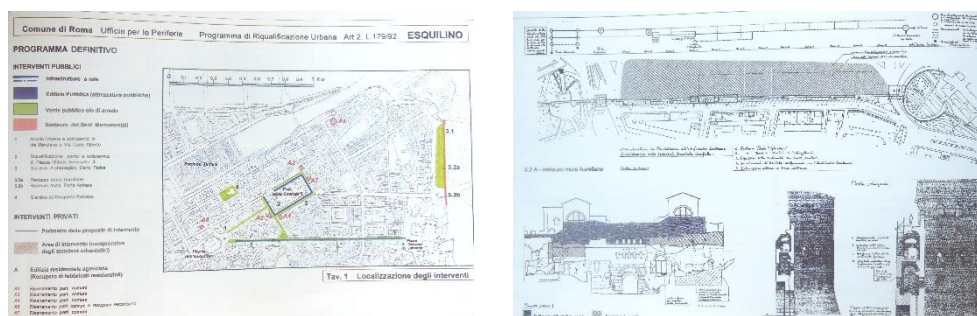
Roma. A sinistra: localizzazione degli interventi. A destra: piante e prospetti del restauro delle mura Aureliane e di Porta Asinaria.
